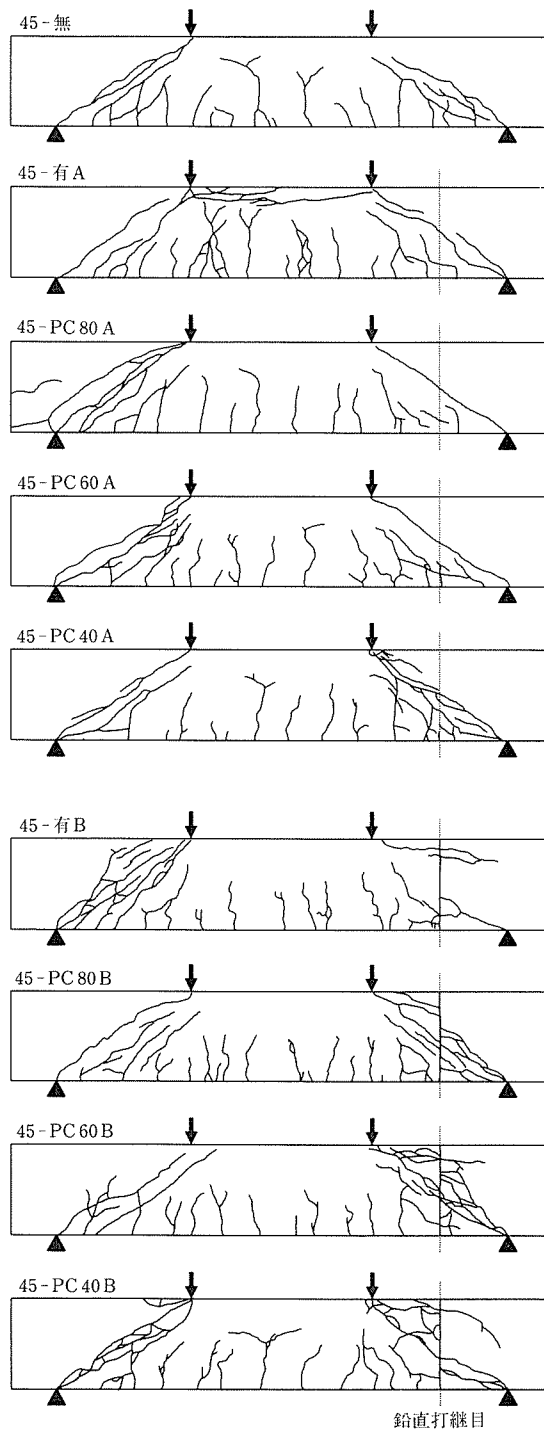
ひび割れの発生状況 (通常強度コンクリート梁)
